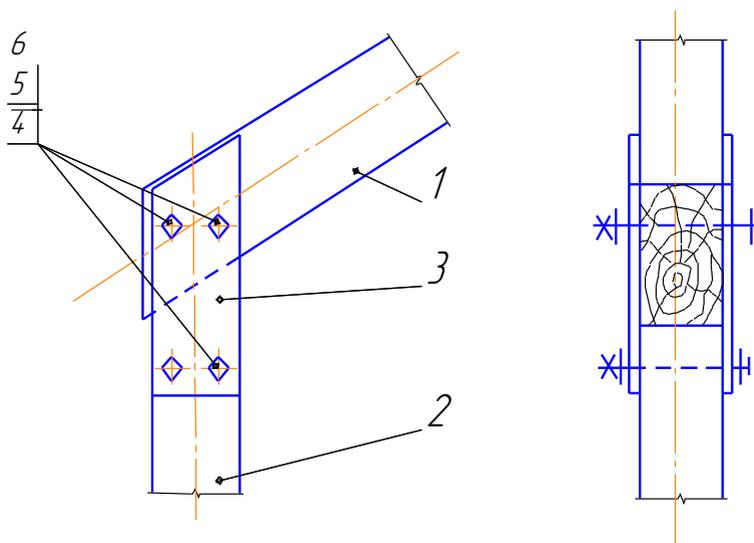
Соединения стяжными болтами: 1 – верхний пояс; 2 – стойка; 3 – металлическая планка; 4 – болт; 5 – гайка; 6 – шайба
